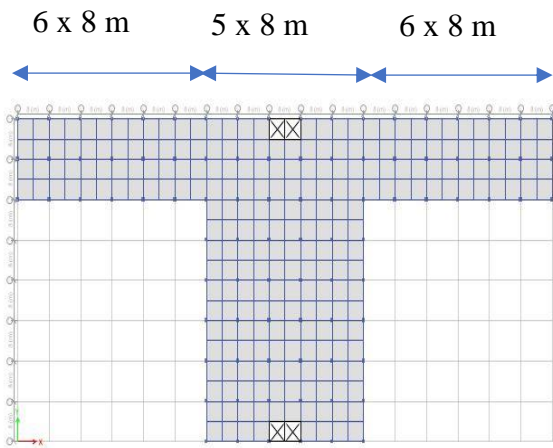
Denah Lantai 7 - Lantai 8 Model A1
